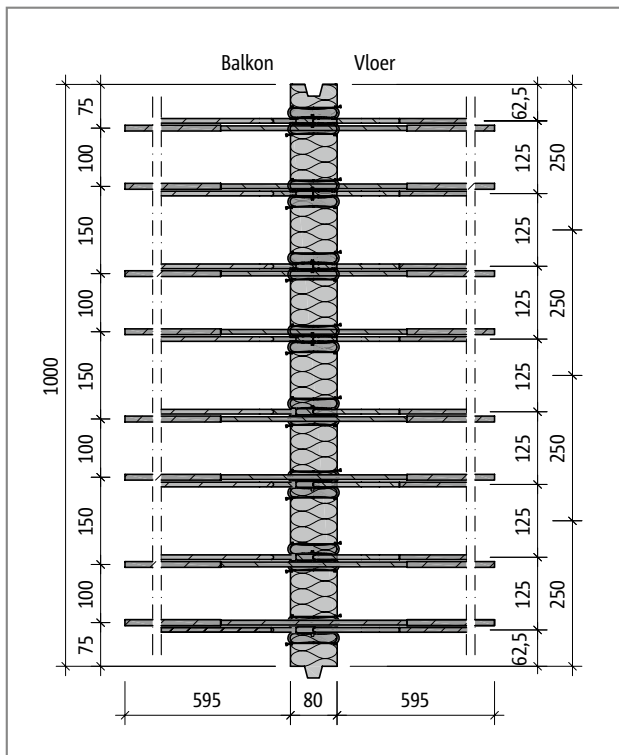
Schöck Isokorb® T type K-T-M1, K-E-M2, K-T-M3: Zijaanzicht
